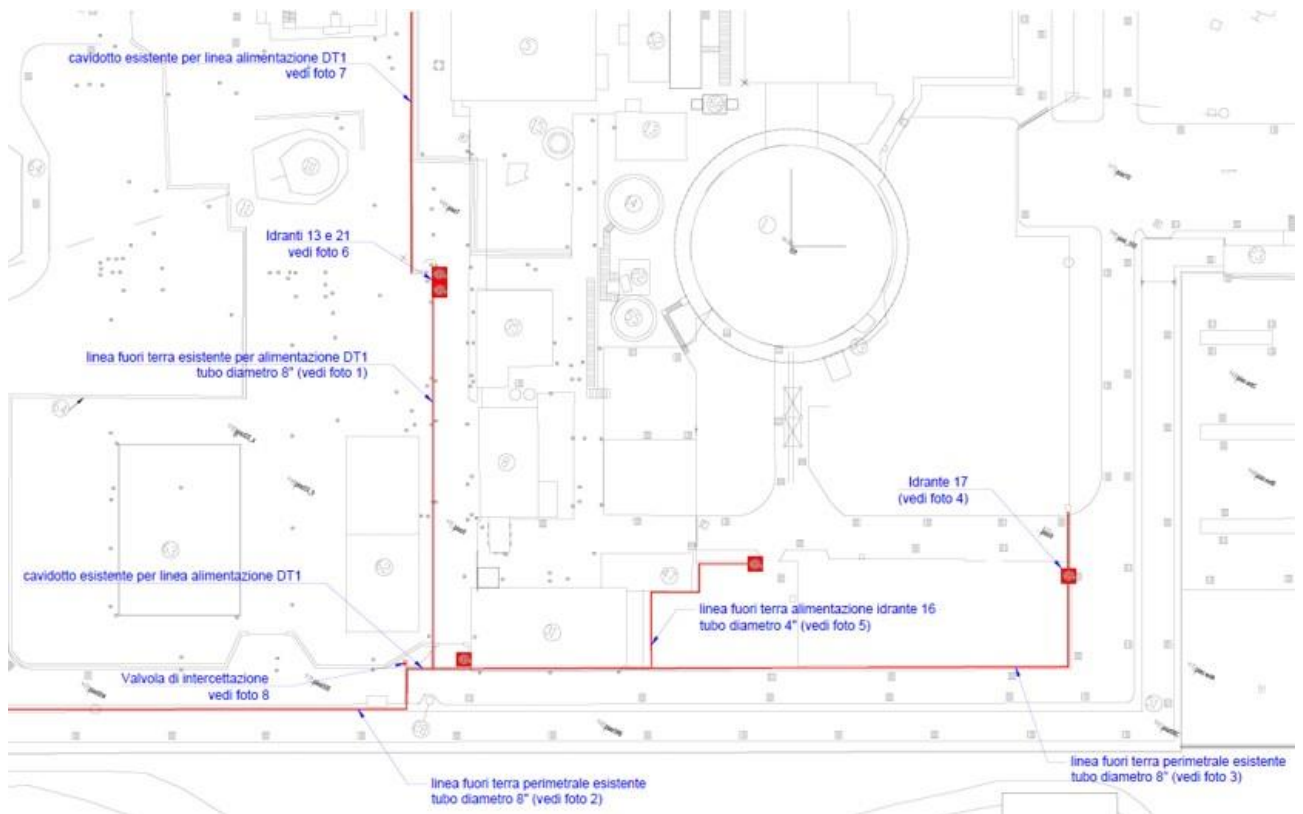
Planimetrie dei tracciati del sistema antincendio (ante-operam) (tratto da GRDT01355_00)
